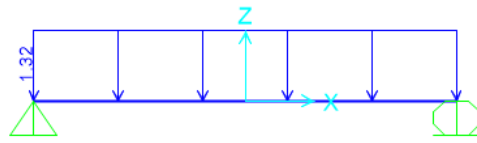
Modelo estructura losa maciza tipo I (ton/m)
